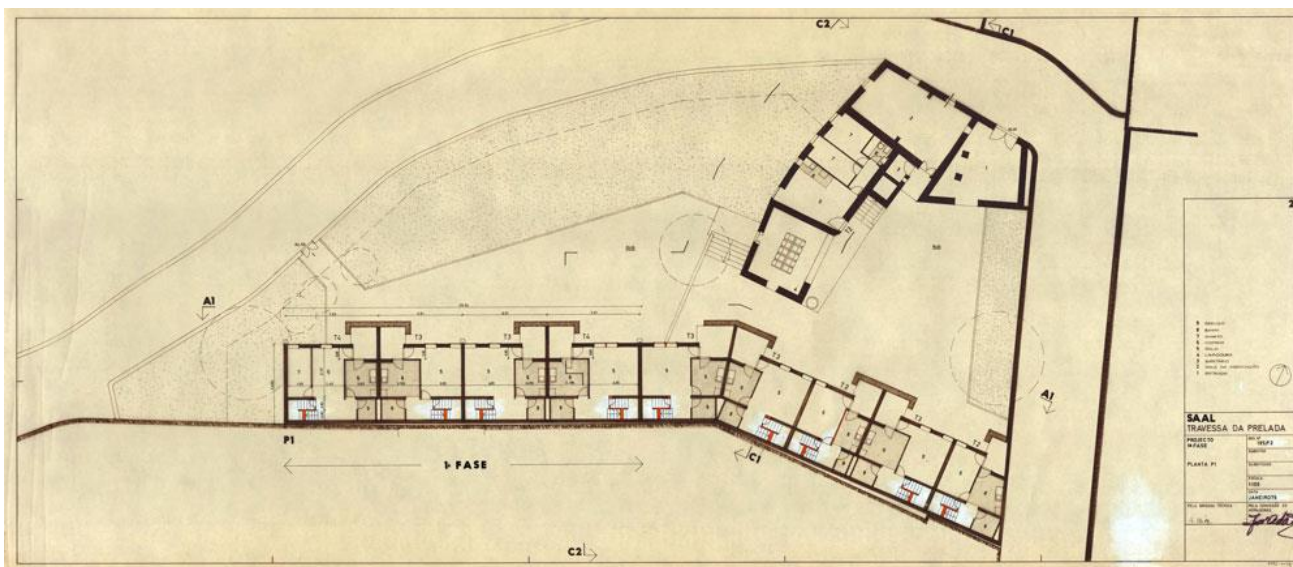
Projeto 1ª fase: Plantas P1. Fonte: © Fundação Marques da Silva, Fernando Távora
